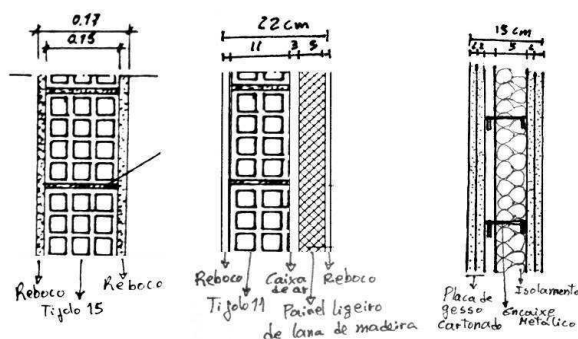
Constituição de uma parede interior tradicional de tijolo, de uma parede mista de tijolo e madeira para melhor isolamento acústico e uma parede em tabique e gesso cartonado (Ilustração nossa, 2014)
